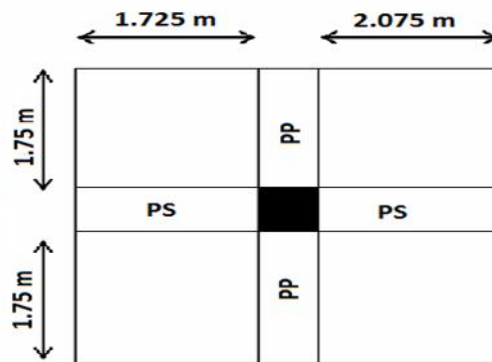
Surface du plancher revenant au poteau le plus sollicité (B5)
